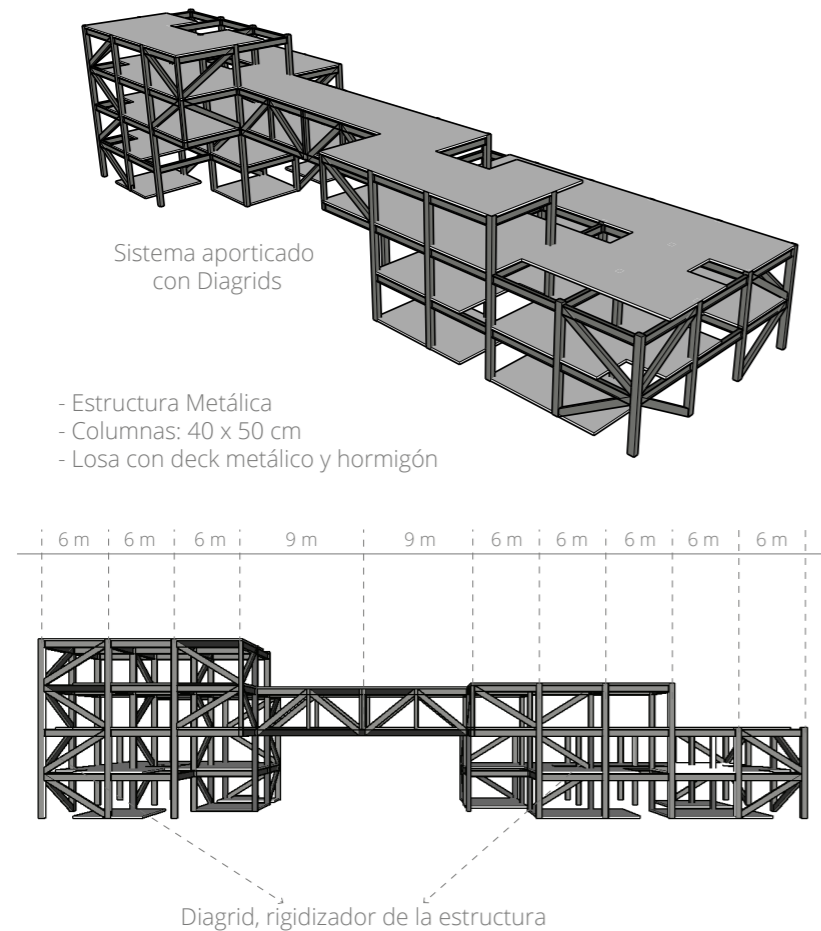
Sistema estructural aporticado de acero con diagonales rigidizadoras.
